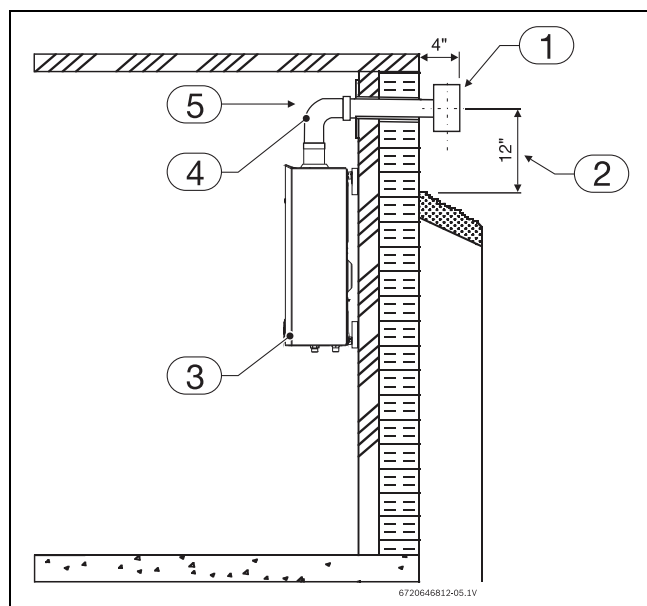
Installation de ventilation horizontale (tuyau d'air de combustion non illustré)
